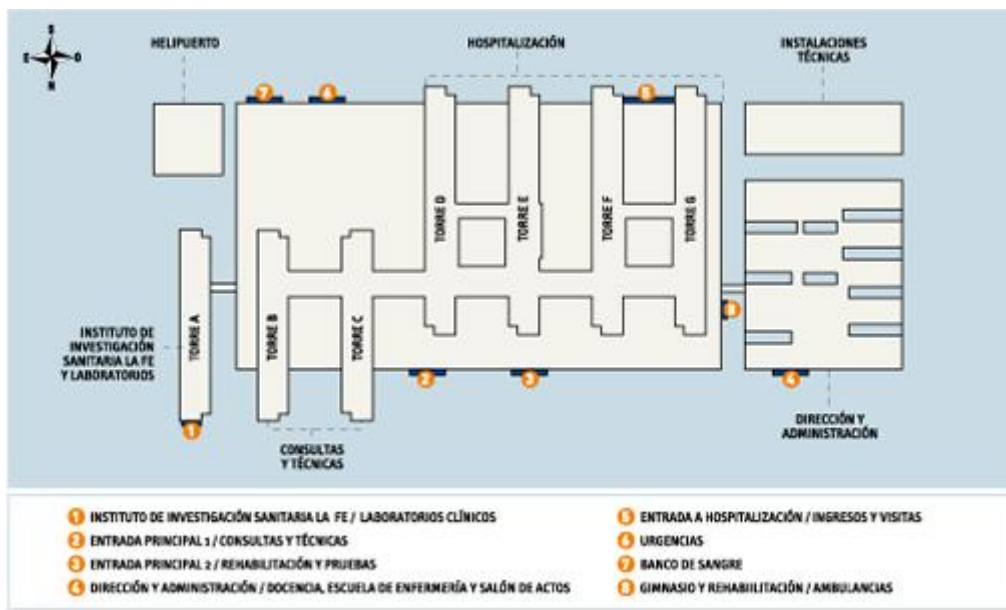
Plano planta Hospital Universitario y Politécnico La Fe
